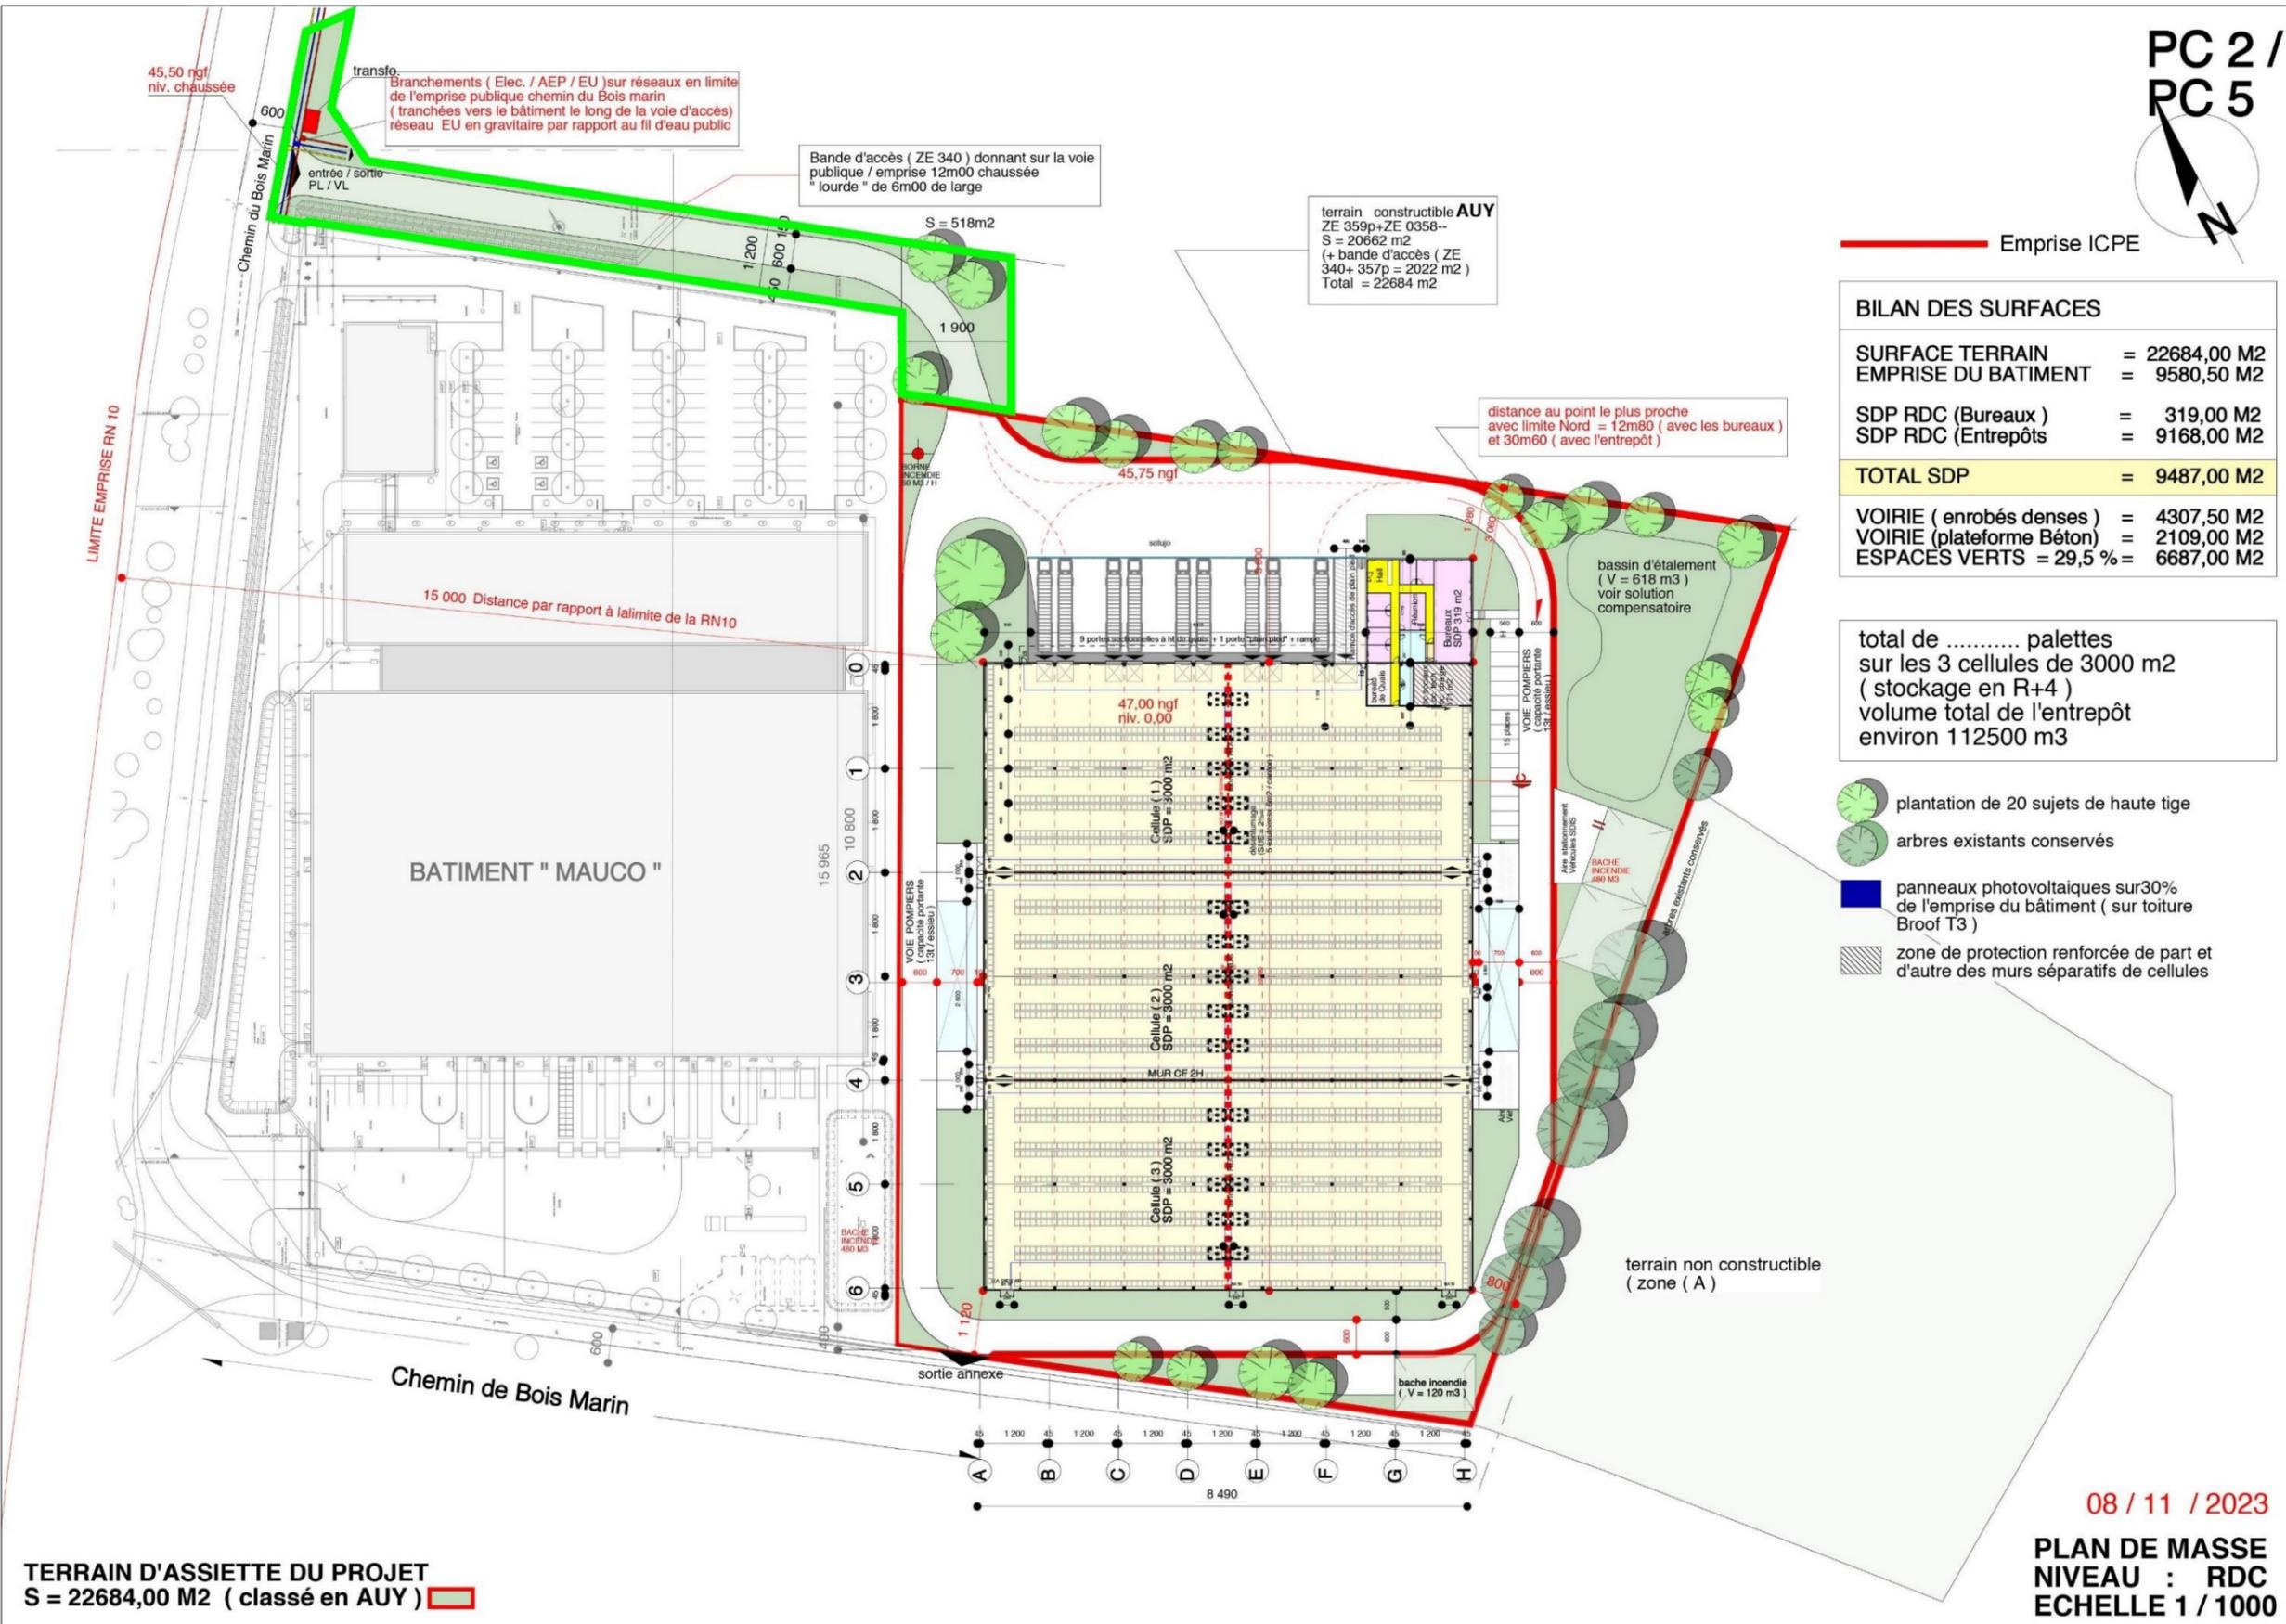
plan de masse (Extrait PC – H.SALADIN Architecte)
